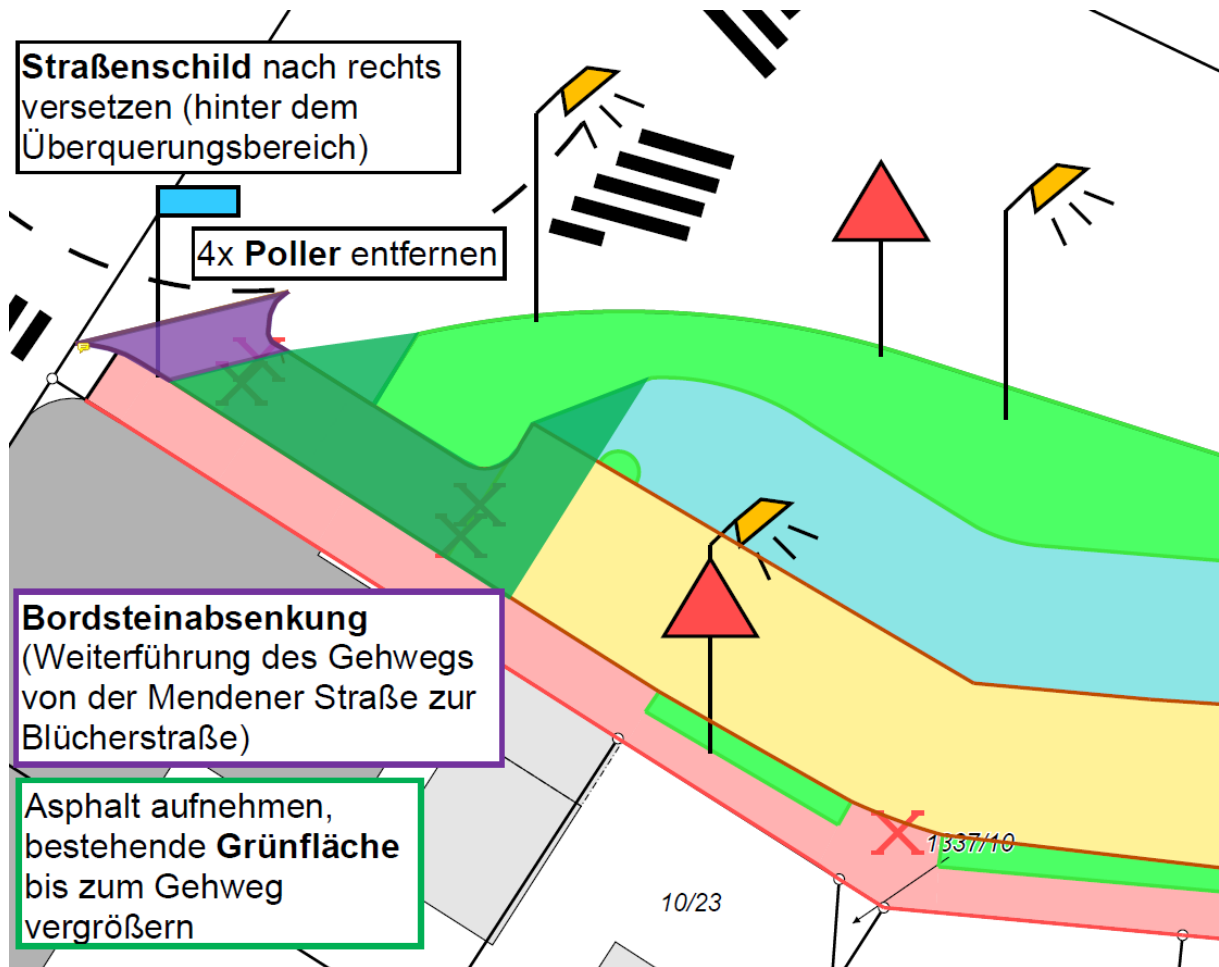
Lageplan Verdiallee; geplante Änderungen
